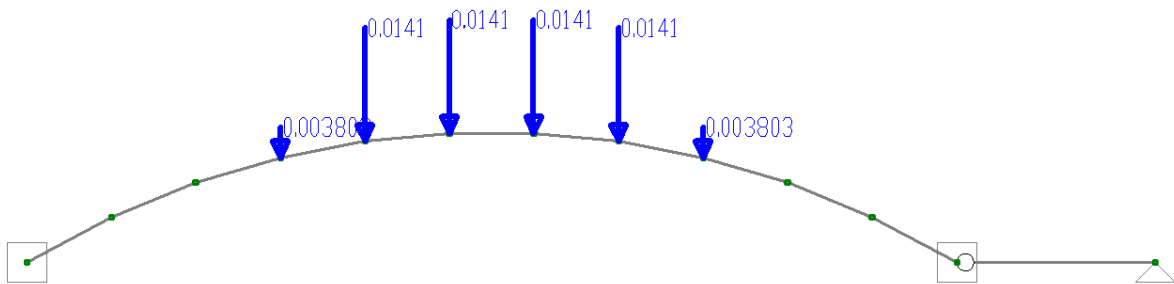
statisches System mit 64 kN Versuchslast; Variante mit verschieblich eingespanntem Widerlager
